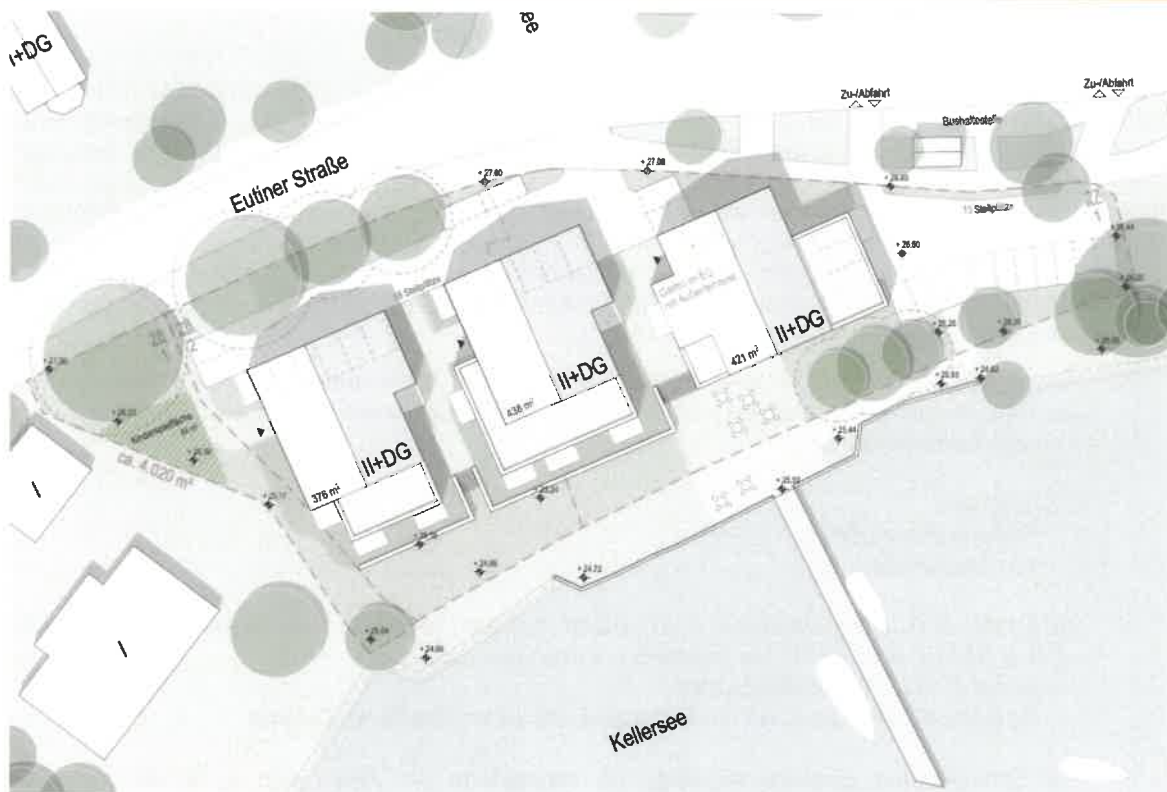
Lageplan Entwurf (Schenk-Fleischhaker Architekten)
